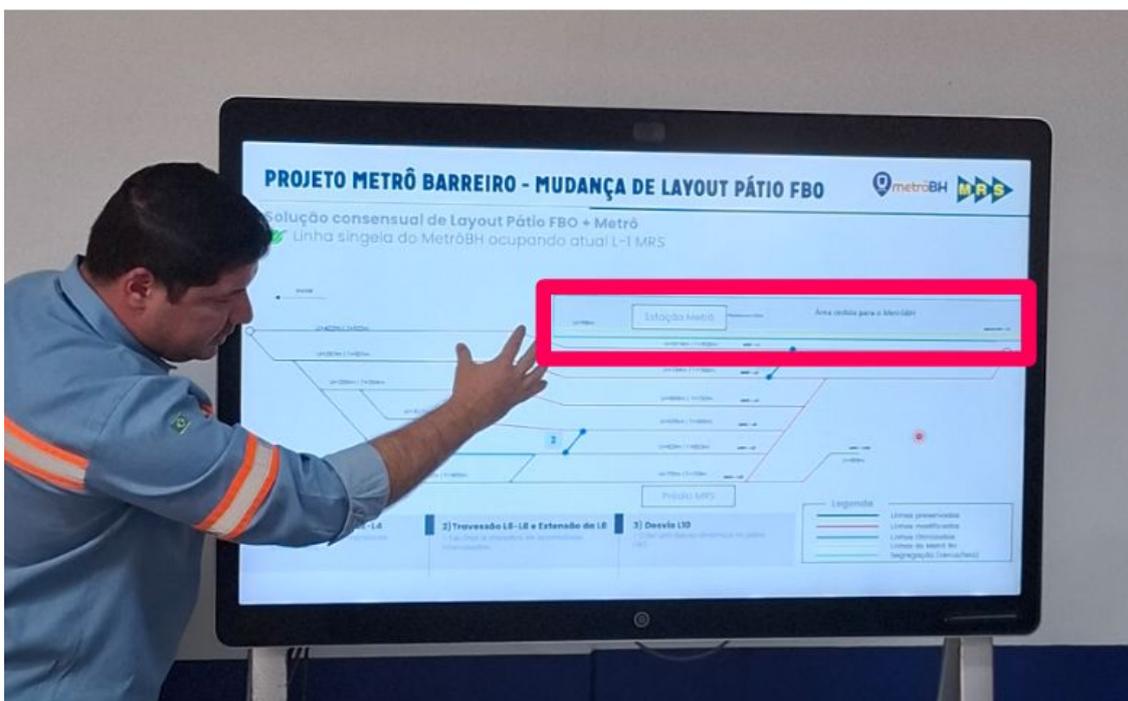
Apresentação pela MRS da situação futura do pátio de transbordo de cargas após a cessão de área à MetroBH. Em destaque, área a ser cedida para implantação da Estação do Metrô Barreiro.
